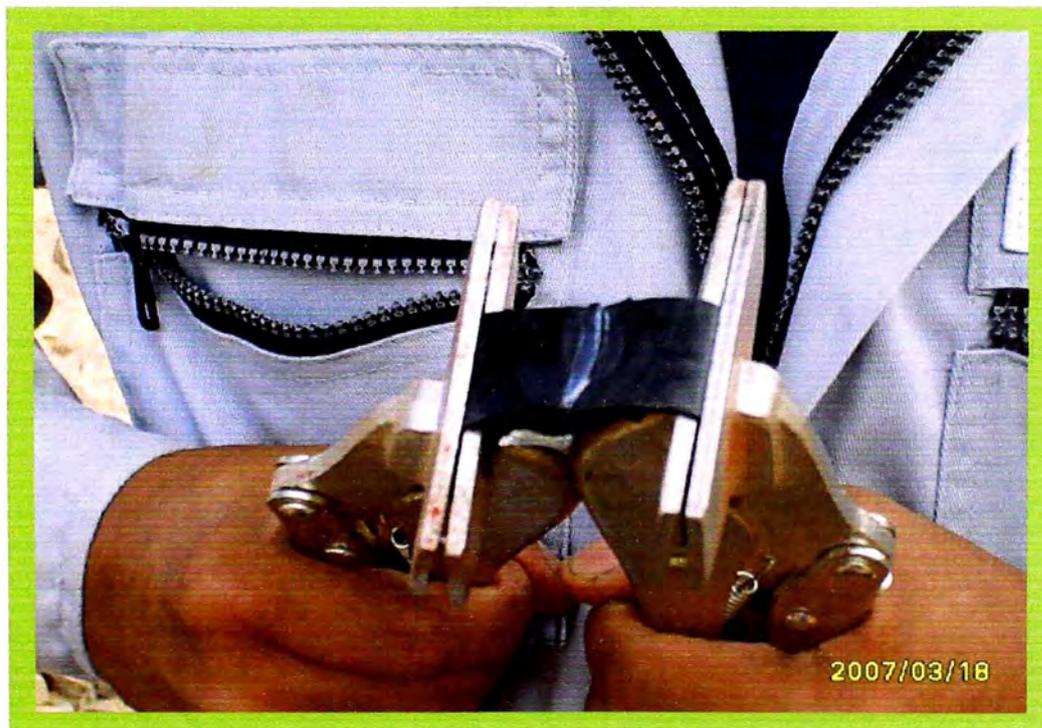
Pruebas de desgarre a la soldadura por extrusión
